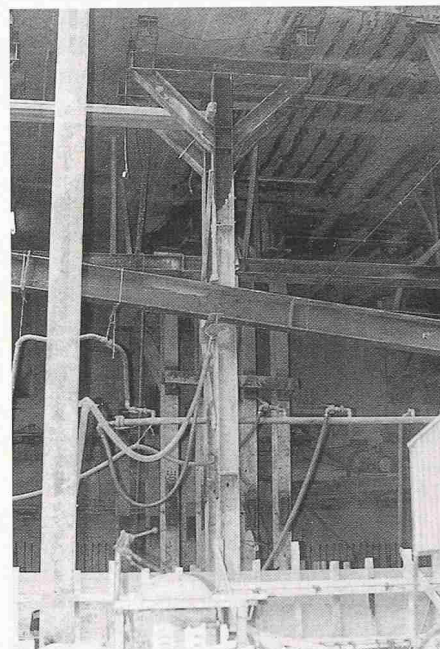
Vertikale und horizontale Abfang- und Stützkonstruktionen im Bereich SBG-Shopville
